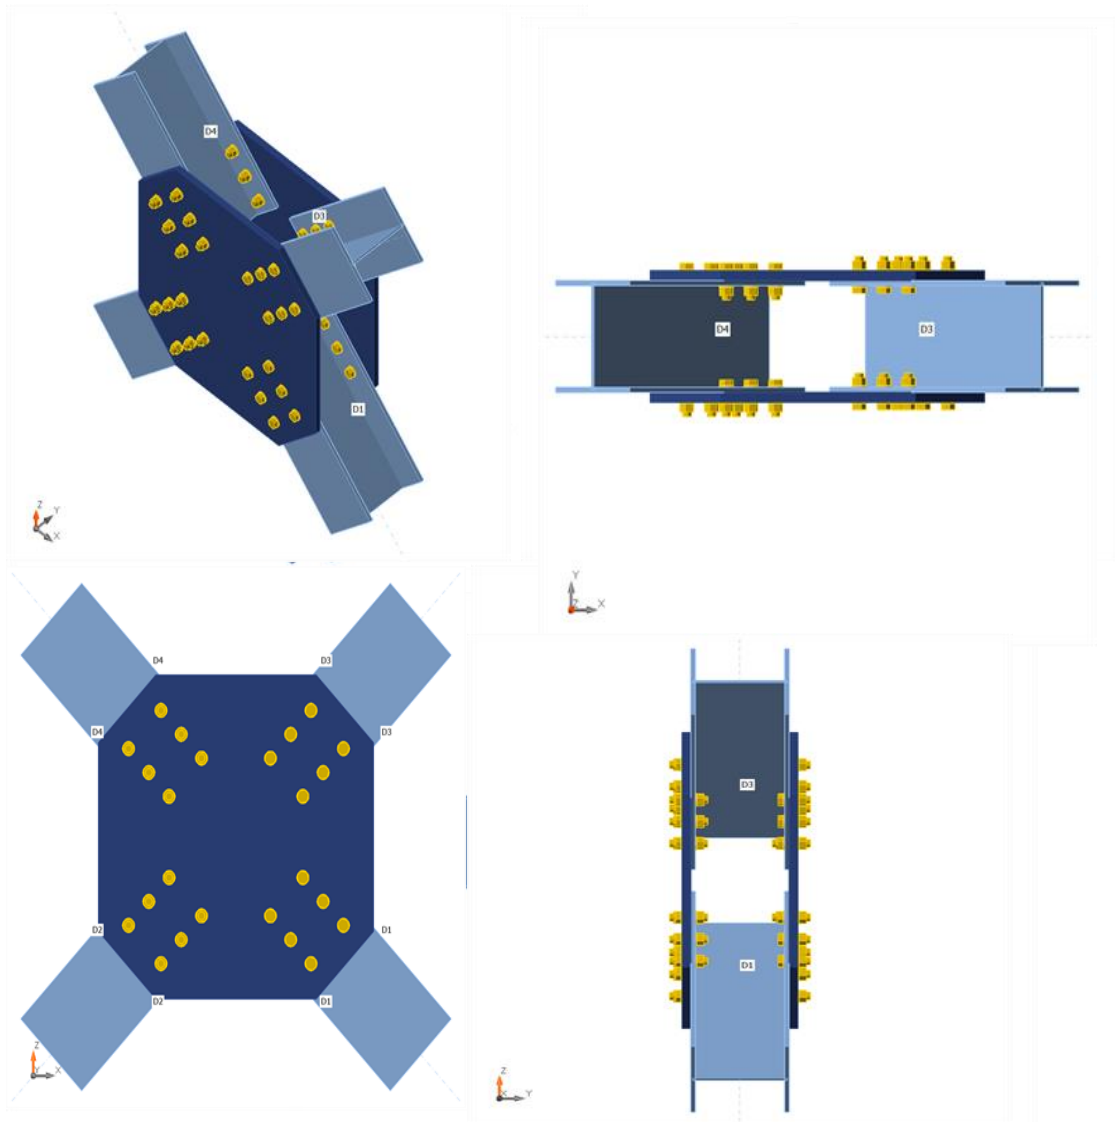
Vue d'assemblage poutre-contreventement-poteau
